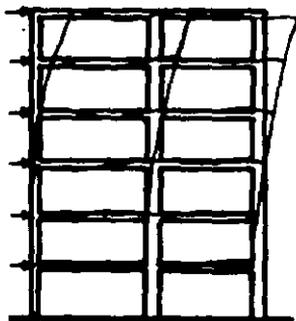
Sistema de marcos con comportamiento estructural de flexión (Cap.5,Ref.3)
